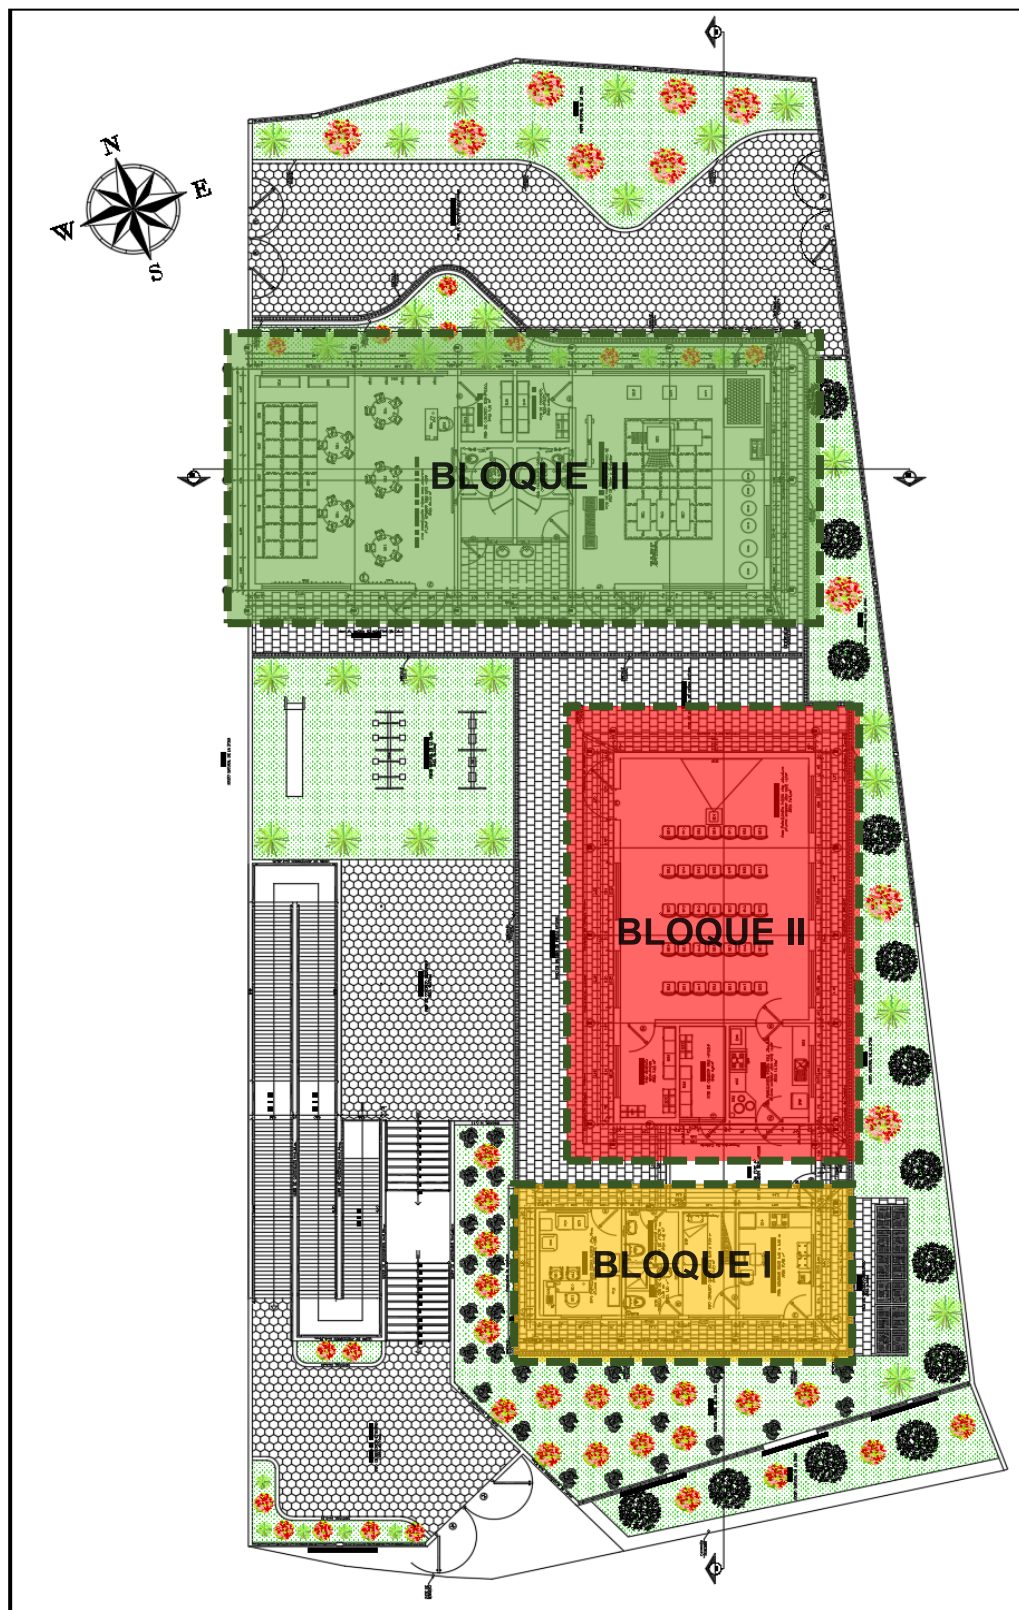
Plano de Planta General de la I.E.I. N° 935 “APOSTOL SANTIAGO”
